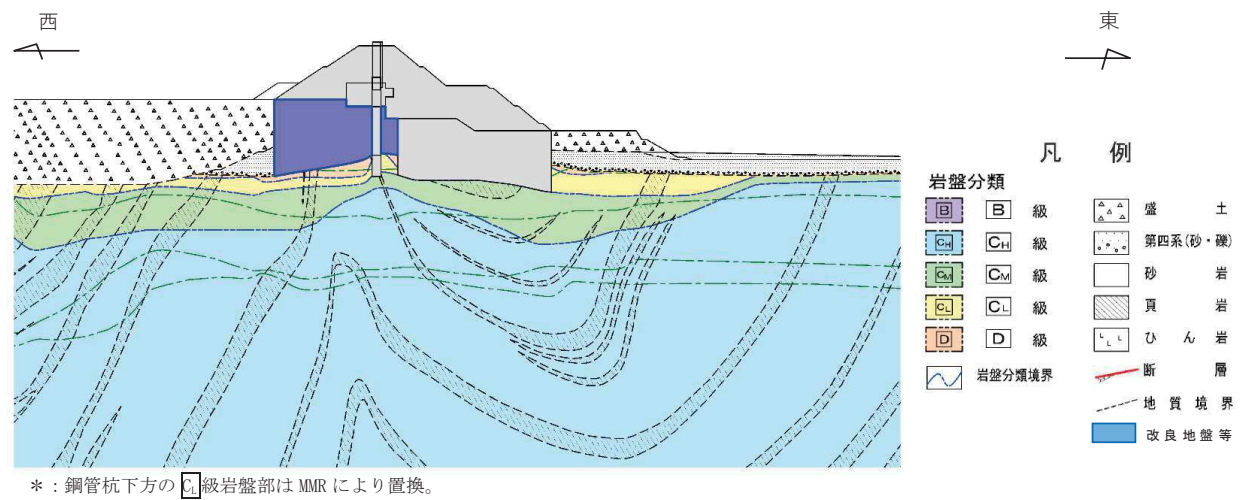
鋼管式鉛直壁（一般部）II-①断面（断面④）
